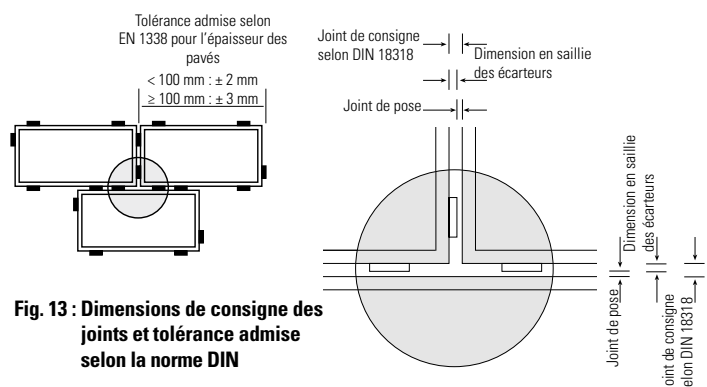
Dimensions de consigne des joints et tolérance admise selon la norme DIN
